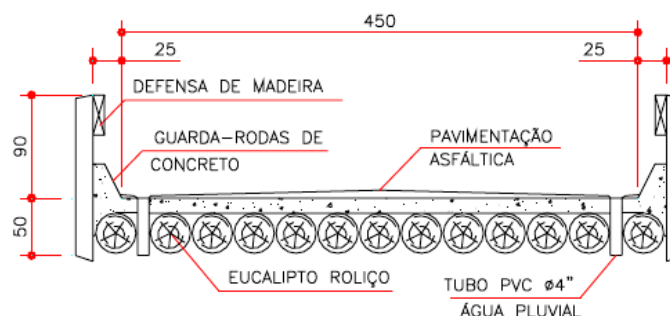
Exemplo de seção transversal em placa mista de madeira-concreto
